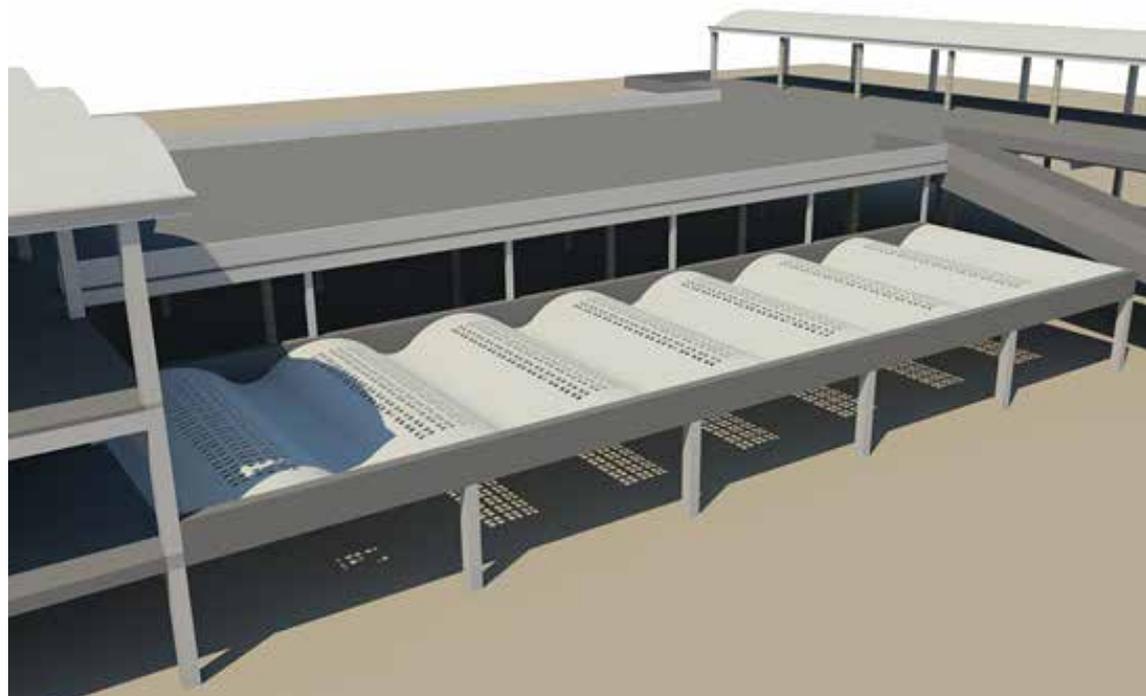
Reconstrucción digital del sistema de membranas descolgadas
